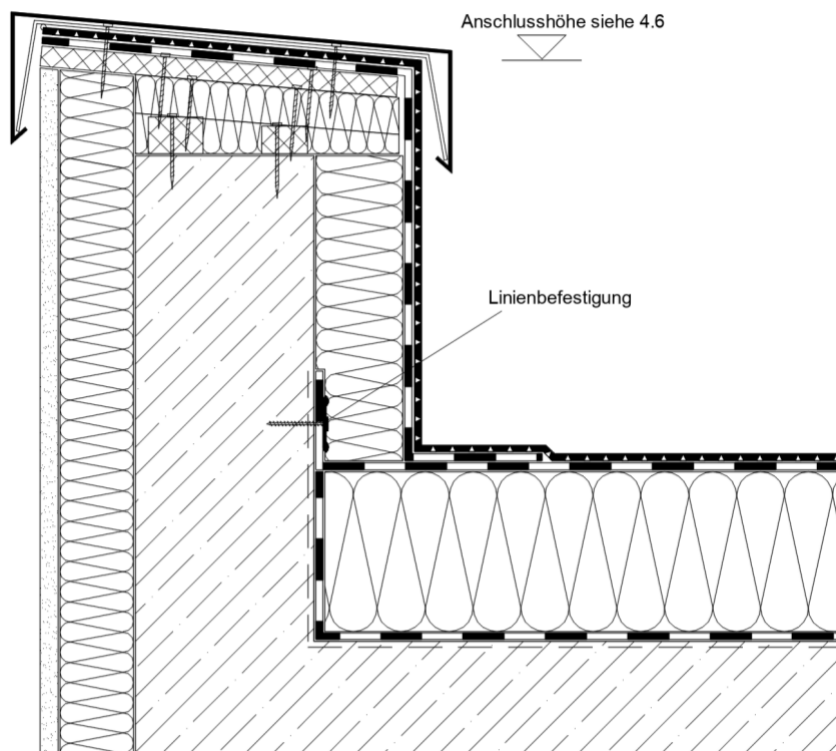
Beweglicher Dachrandabschluss – Ausführung mit Bitumenbahnen
